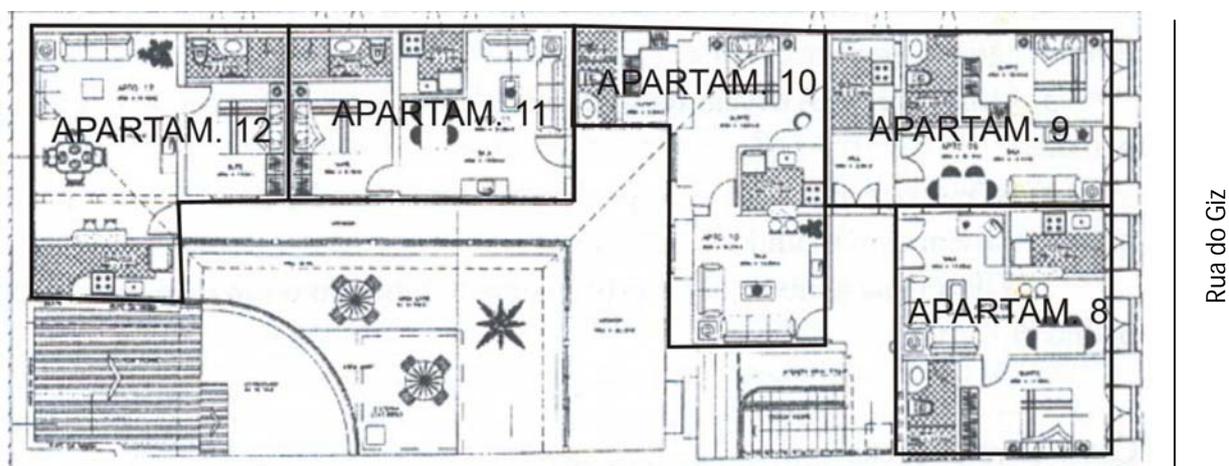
Planta do 2º pavimento na rua do Giz nº 117 – sem escala LIMA et al, 2004, p.131; AZEREDO, 2006, p.53.
